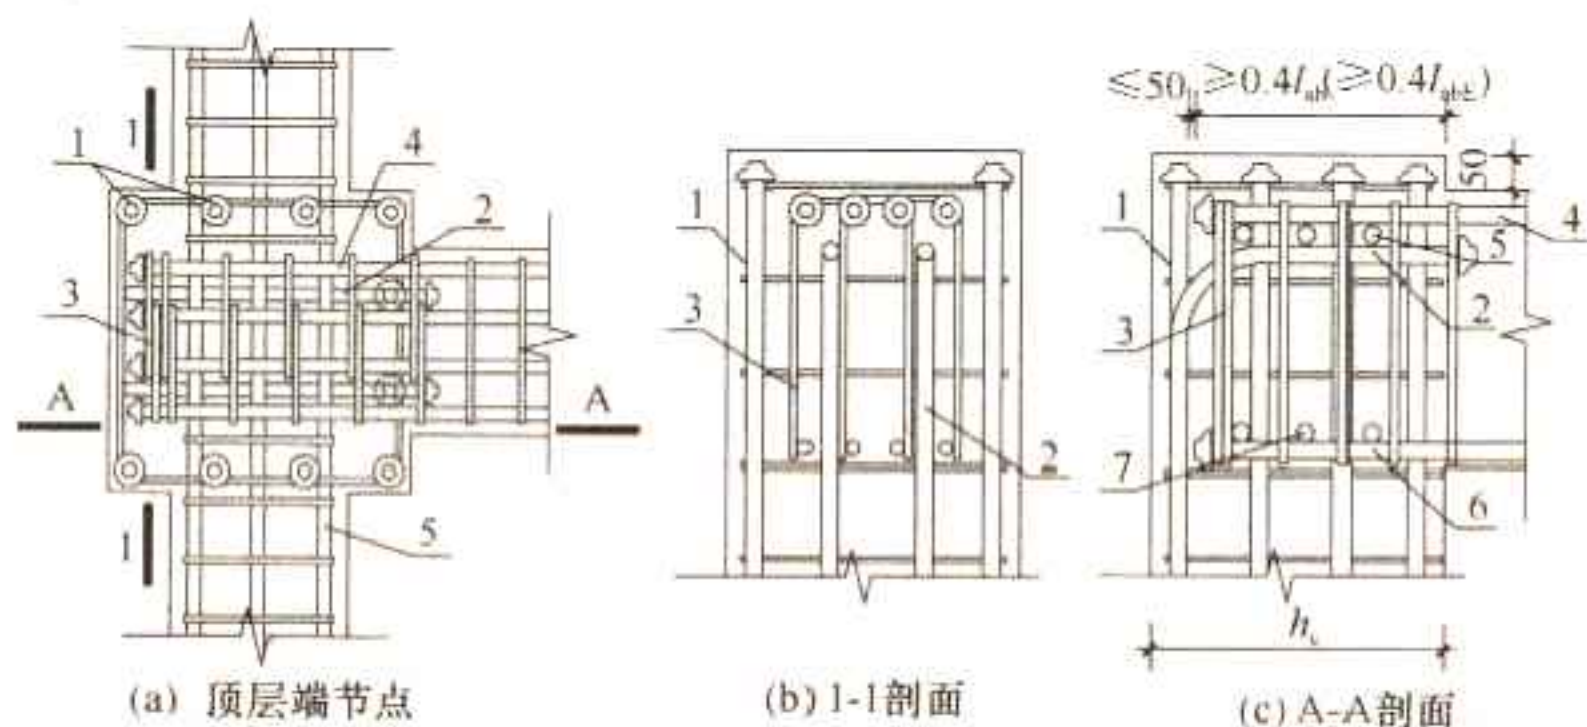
顶层端节点钢筋锚固板布置和节点构造
